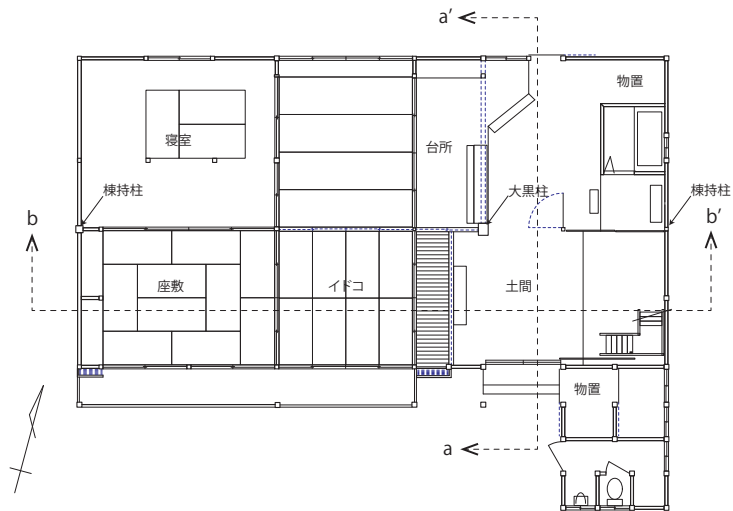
今井秀郎家住宅 1階平面図 1/200
